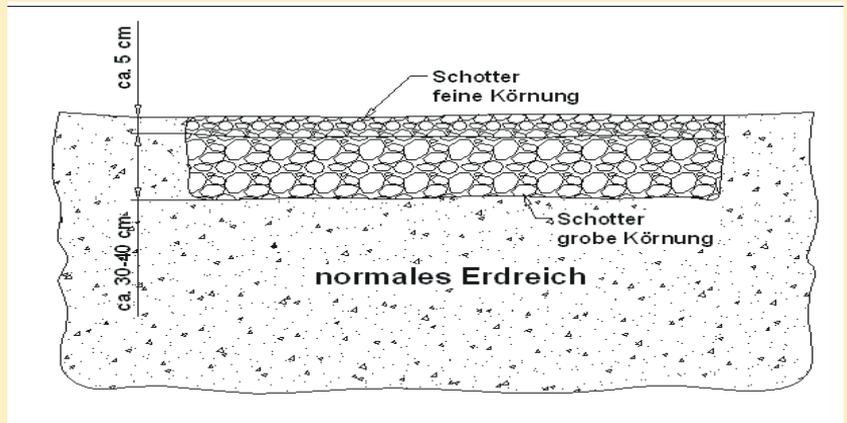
Ausschachtung mit Aufbau Untergrund als Schotterbett
